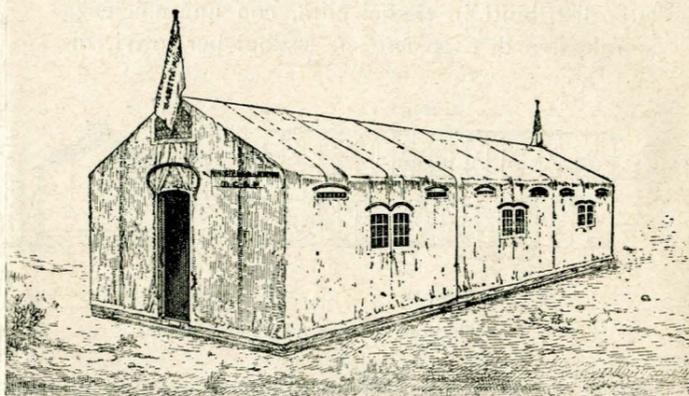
Tenda-baracca Moretti - Prospetto.
